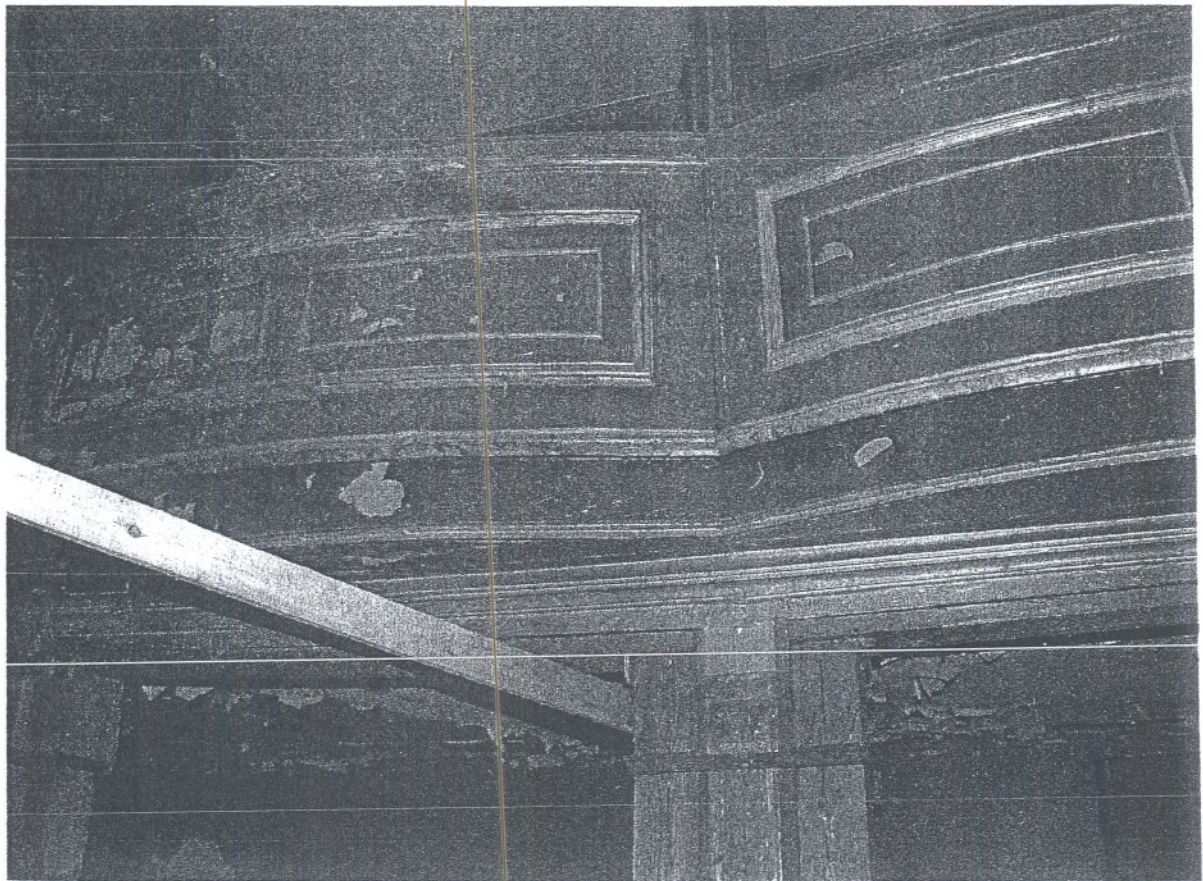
Teatr Stary w Lublinie, ul. Jezuicka18, drewniane loże, stan zachowania przed rozpoczęciem prac rozbiórkowych. II kondygnacja łóż - balkony. Widoczne nadpalone loże
